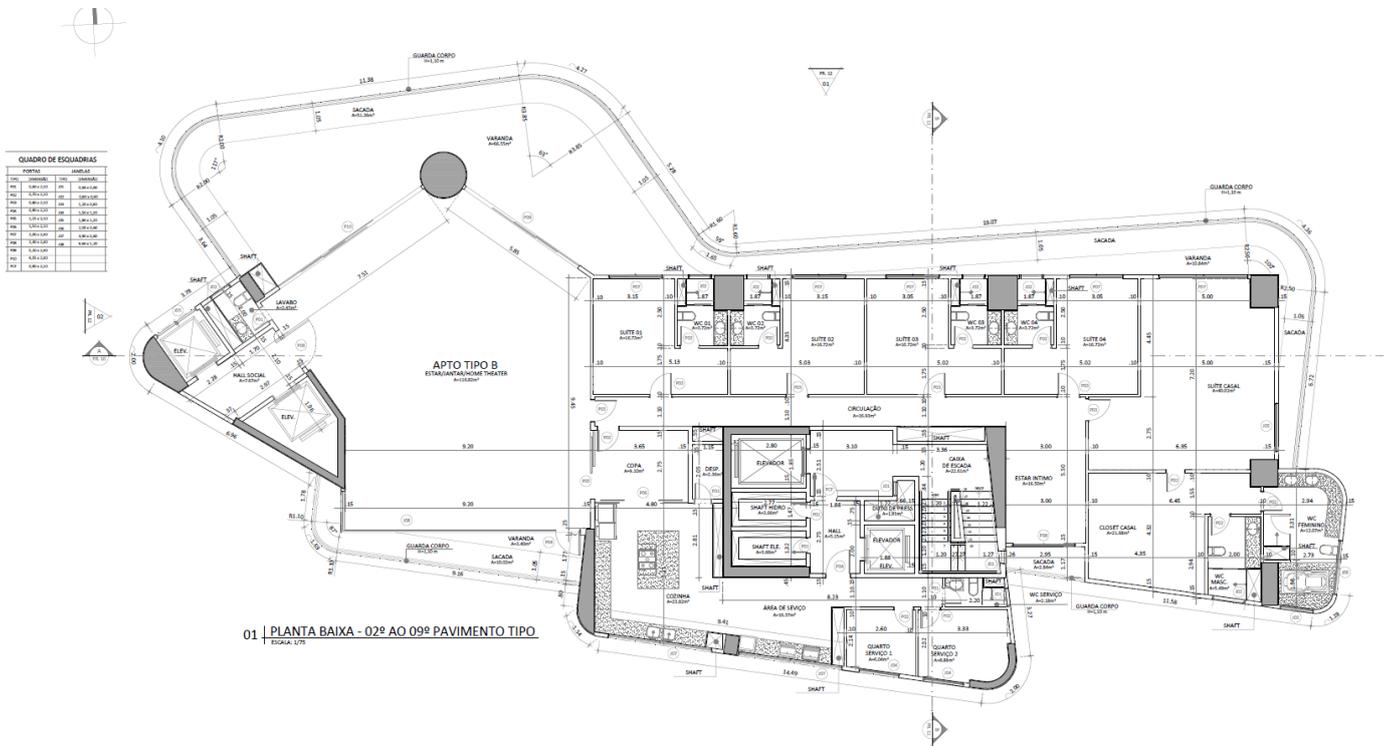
2º pavimento-tipo (Ap. tipo B) / Fonte: Daniel Arruda Arquitetura
